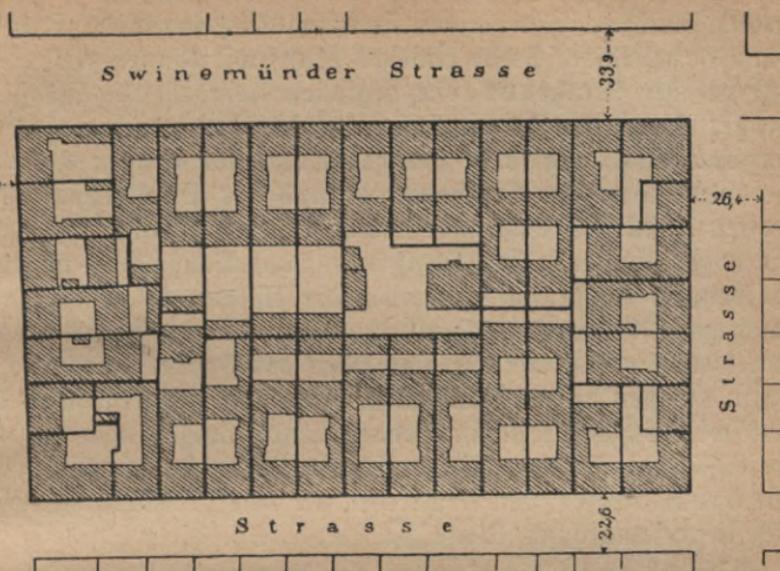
Bebauungsplan und Grundstücksaufteilung. Stadterweiterung Berlin.
